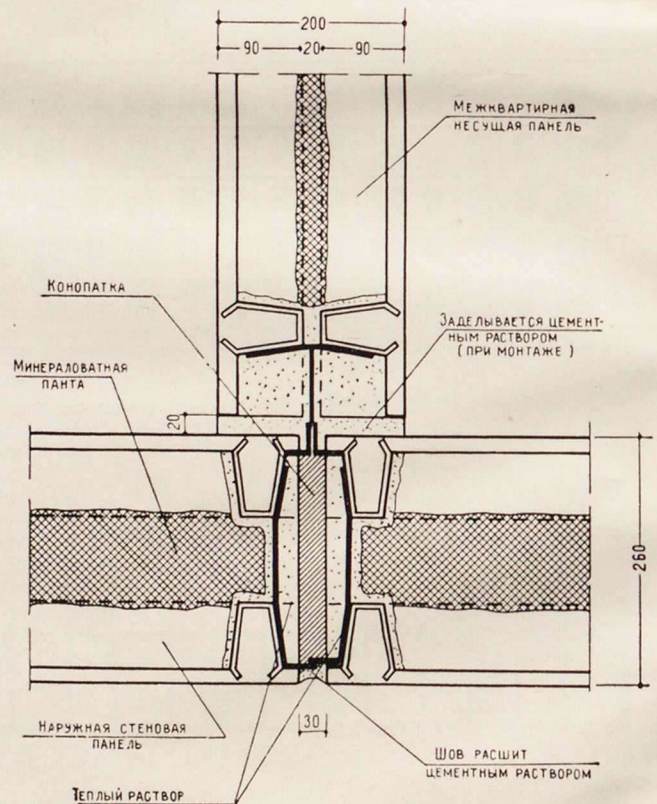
Узел сопряжения панели наружной самонесущей стены с панелью внутренней несущей стены. План
